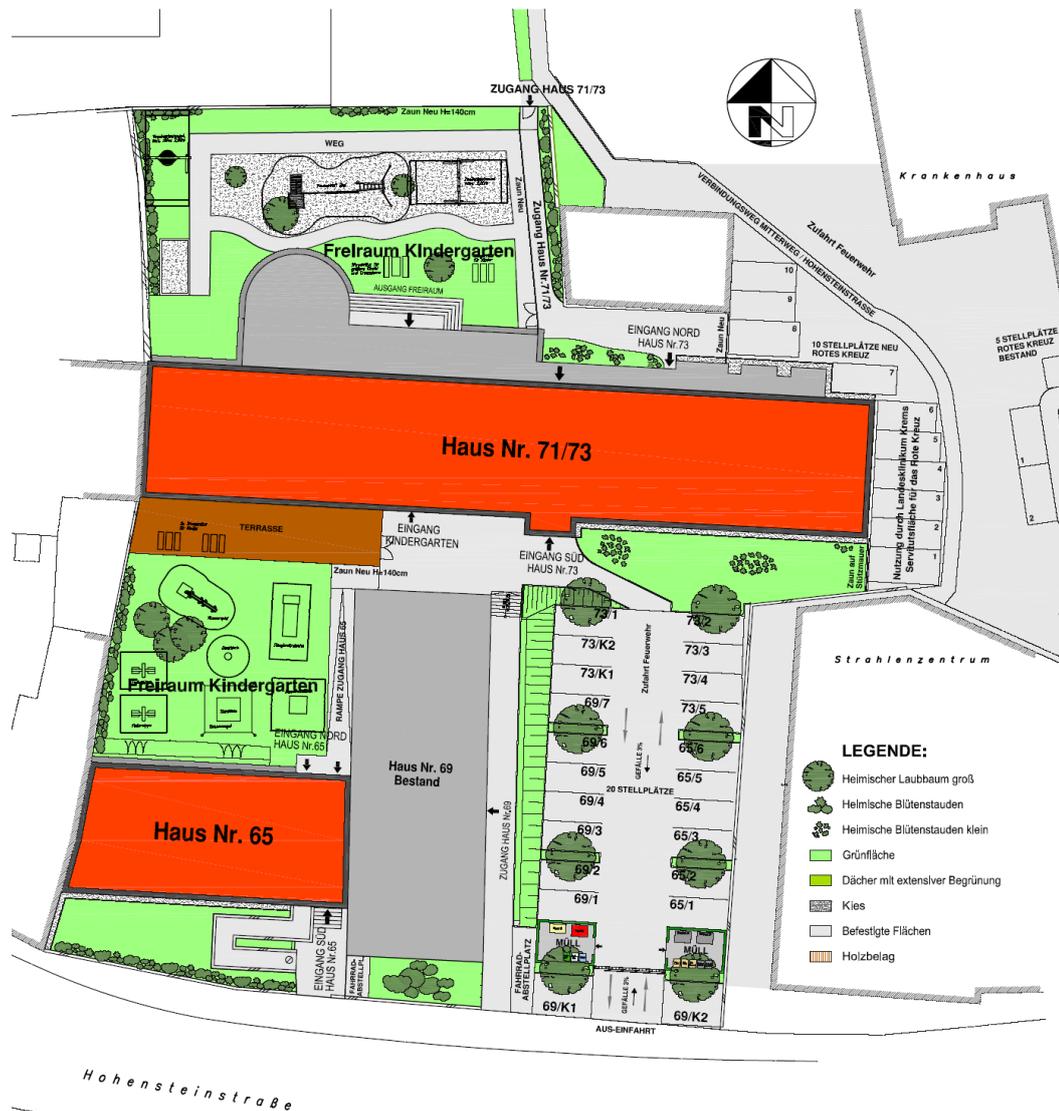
Hohensteinstraße 65, 71, 73, 3500 KREMS, Grundriss
